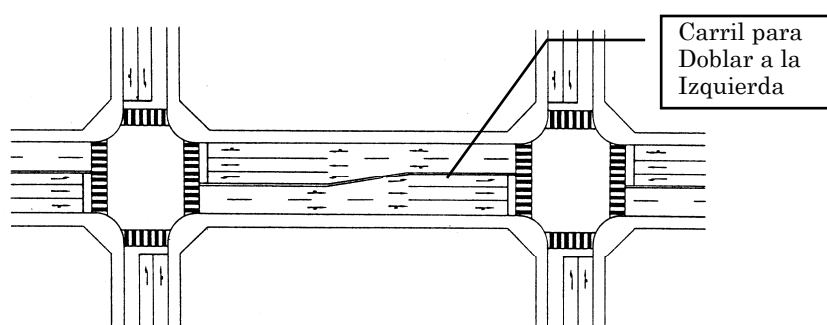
Carril Exclusivo para Doblar a la Izquierda Moviendo la Línea del Centro
